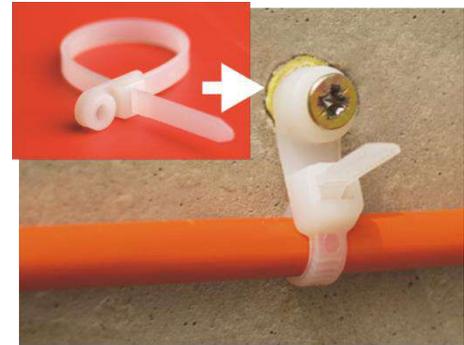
Монтаж ЧЭ ProCab® на стене.
